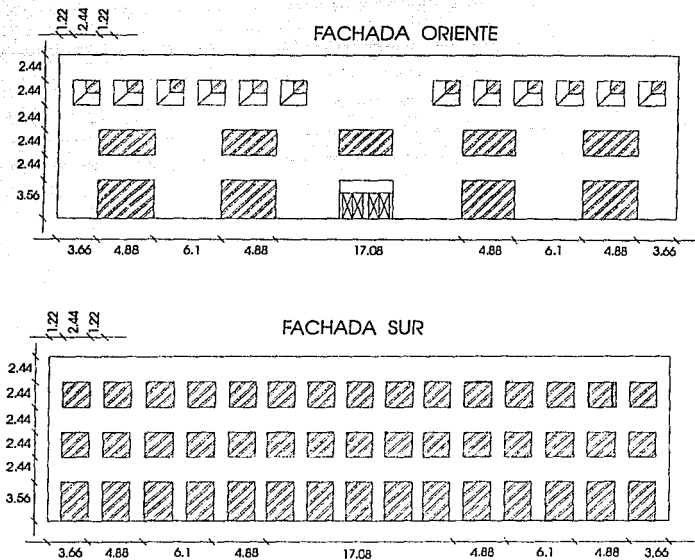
FACHADAS SUR Y ORIENTE DEL EDIFICIO
